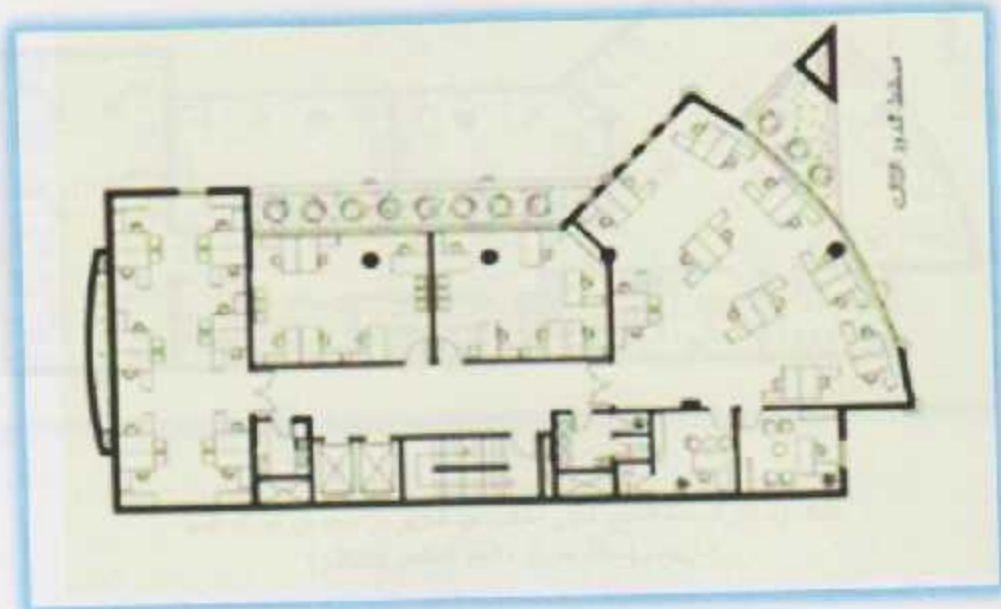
مسقط افقي لشركة تحتوي مكاتب مفتوحة ومغلقة
